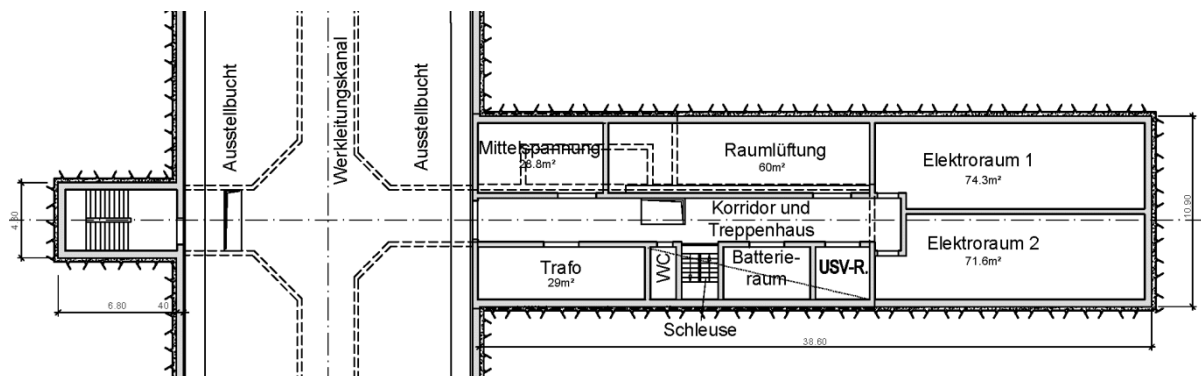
Grundriss Mittelzentrale
